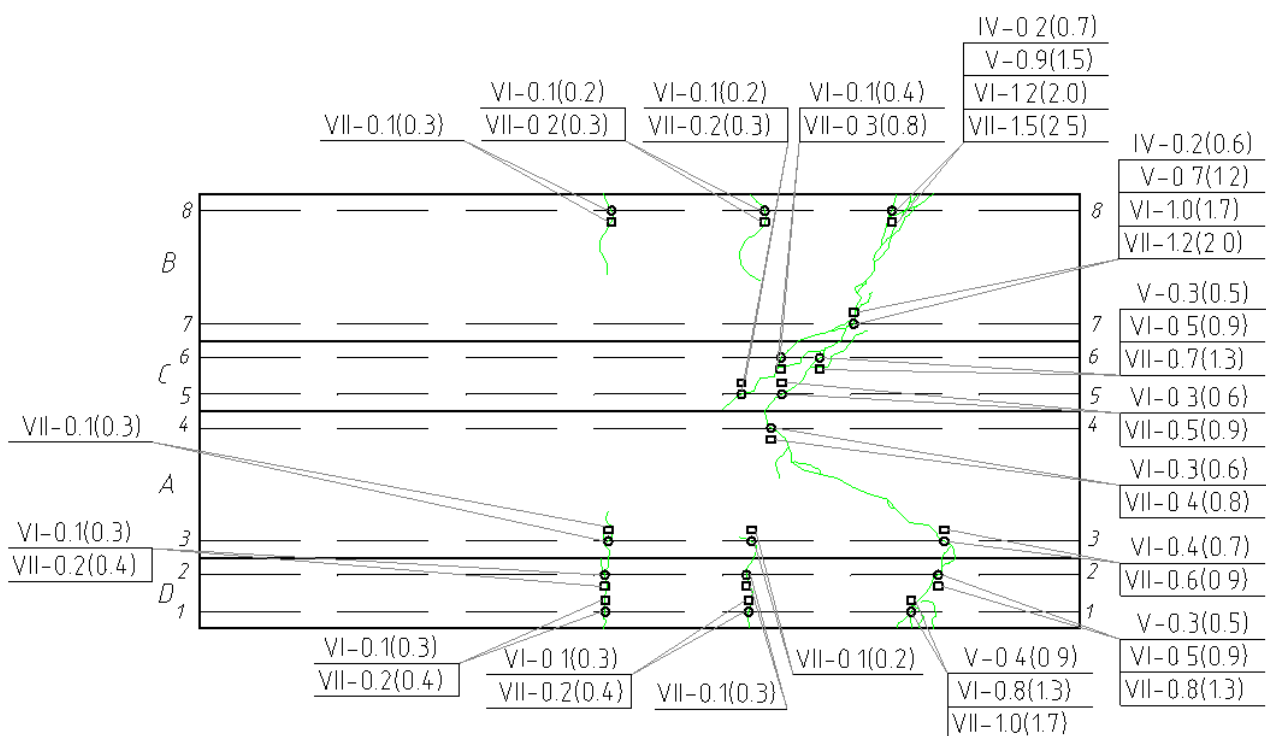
Раскрытие трещин в экспериментальной железобетонной конструкции С4-Б1
